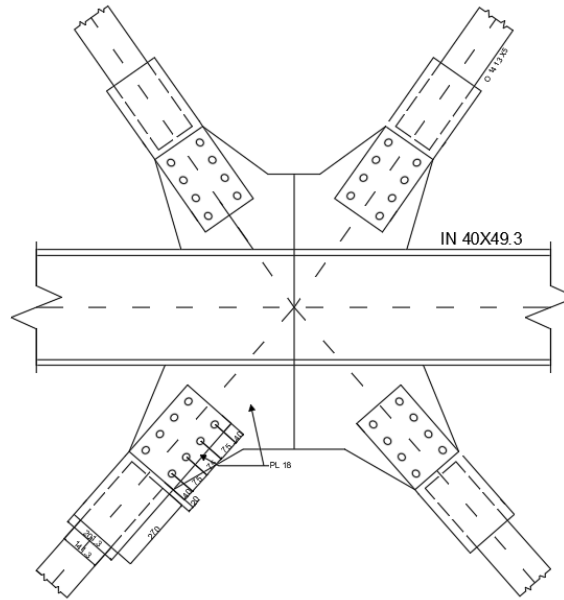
Detalle disposición X perfil O 141.3x5 conexión con viga.
